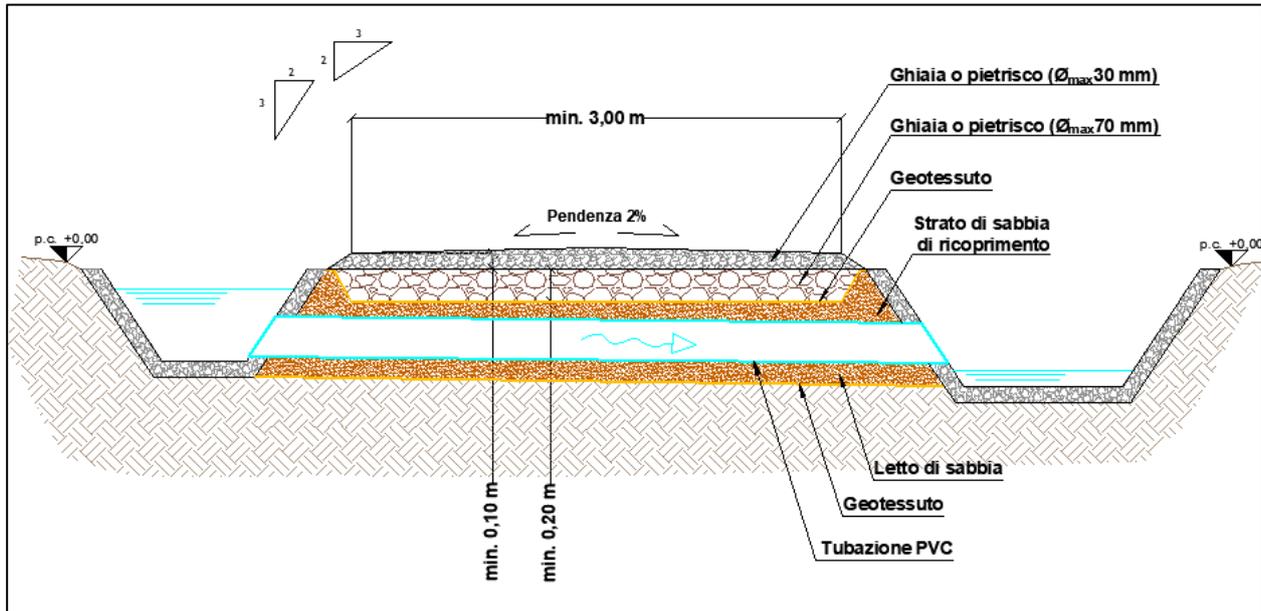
Tipologico sezione stradale viabilità interna con attraversamento tubo di drenaggio acque meteoriche
